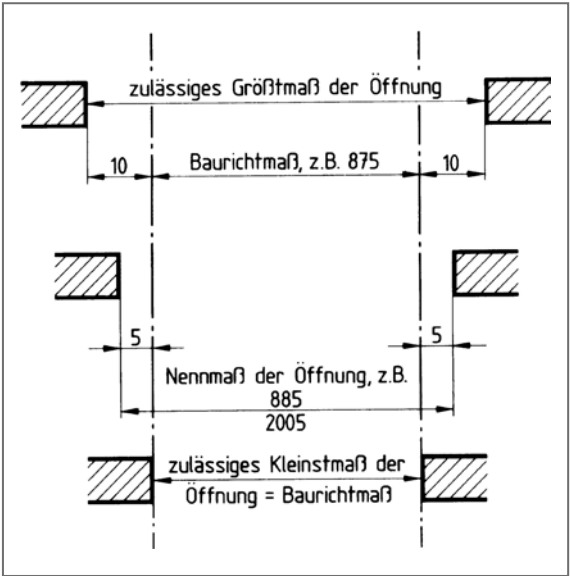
Grundriss für Breitenmaße [Quelle: DIN 18100:1983-10, Bild A.2]
